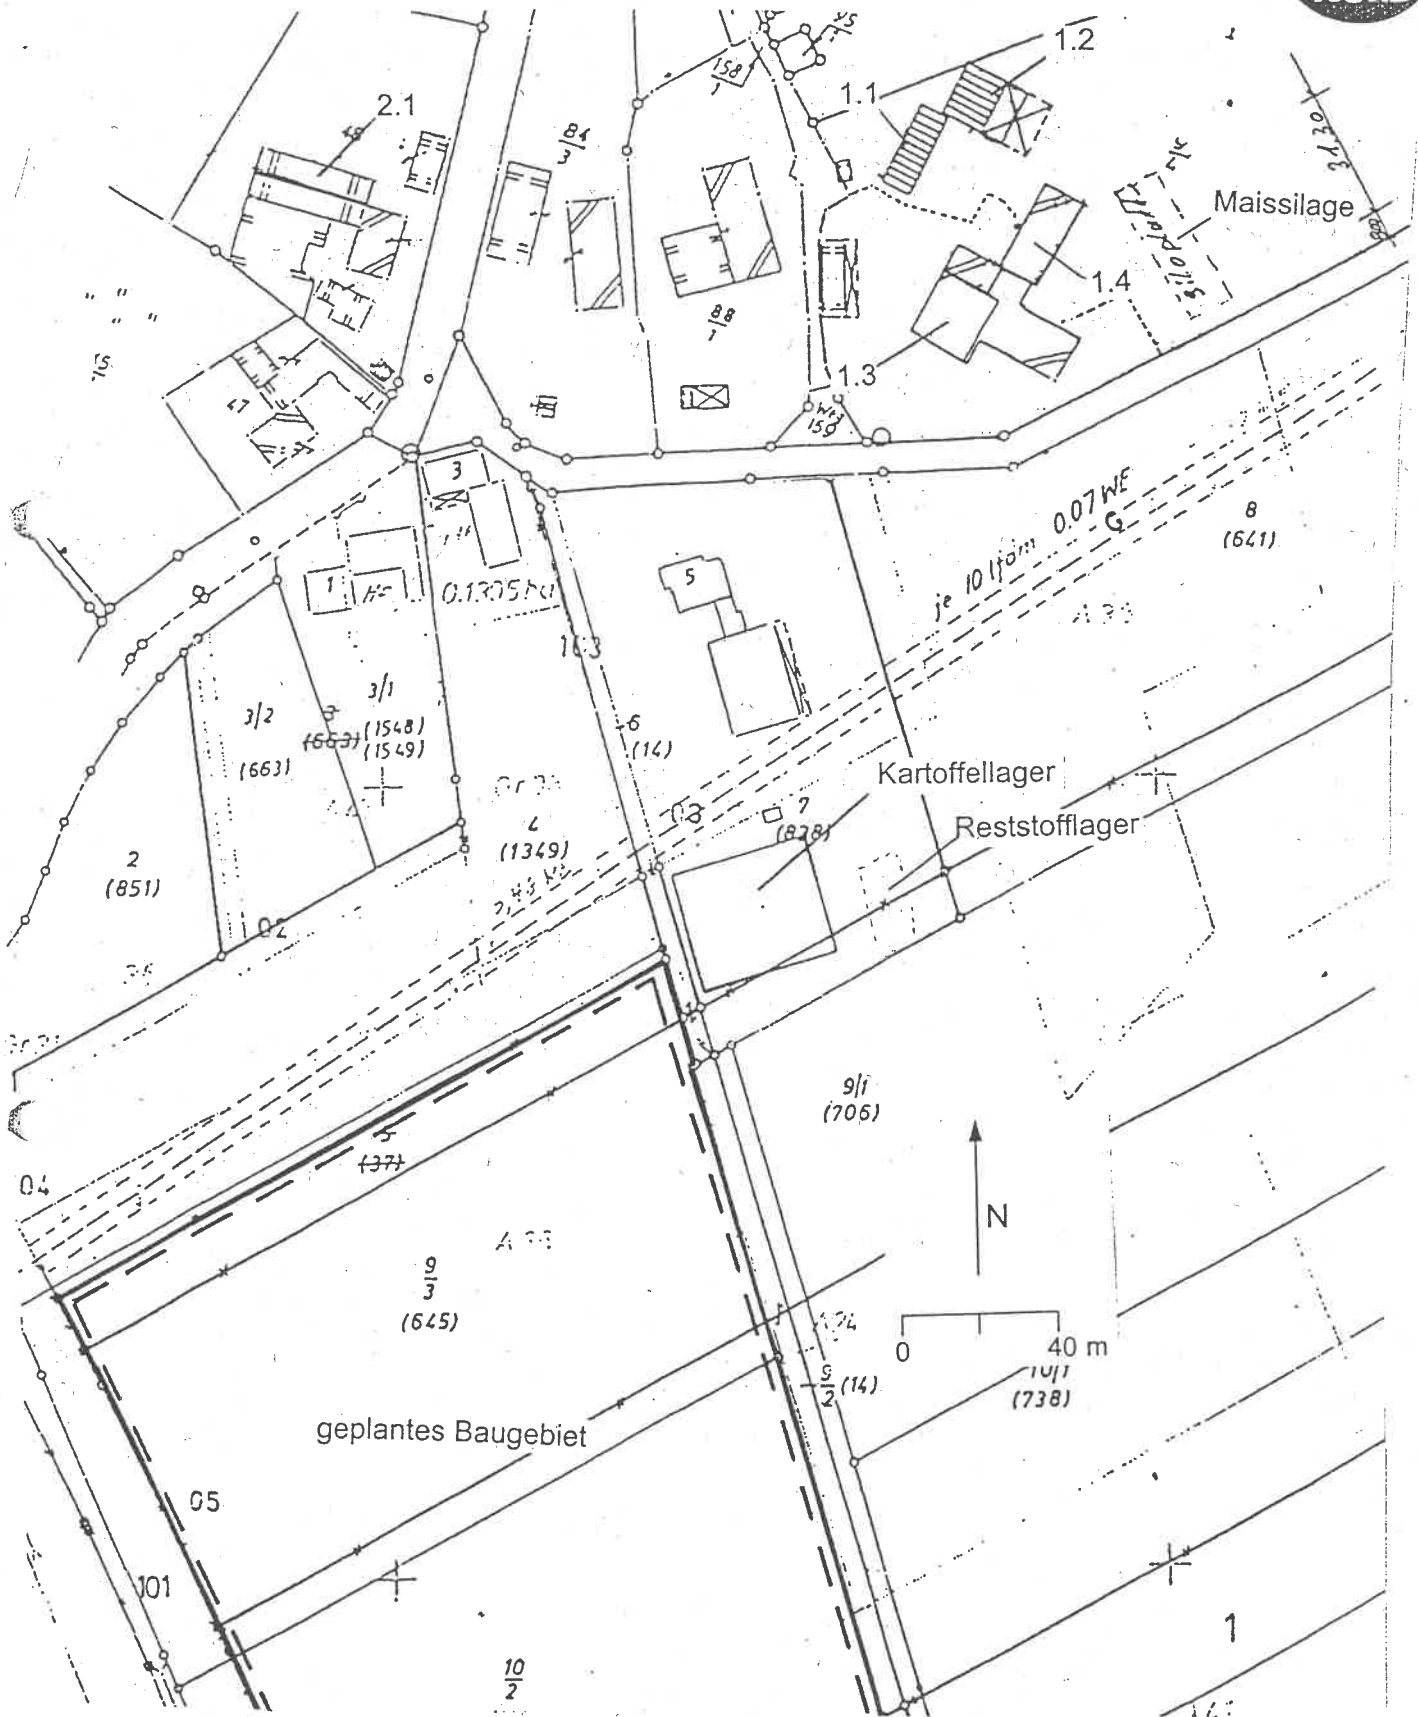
Lageplan (Maßstab 1:2000); Geruchsquellen der Betriebe
